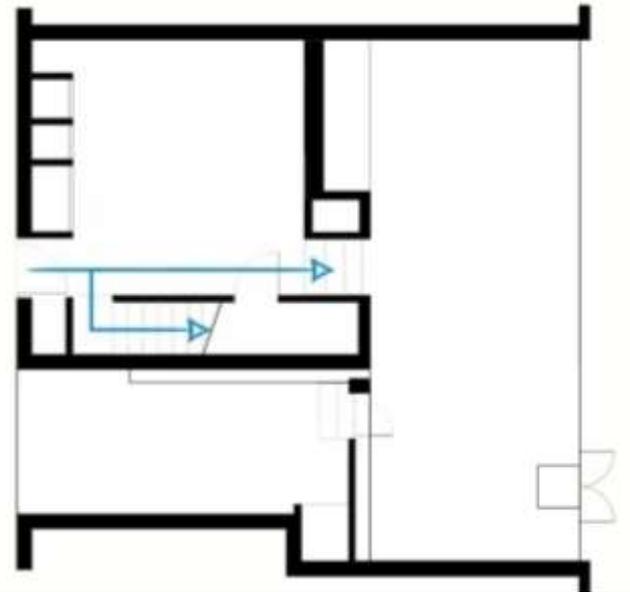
Planta de Murray Mews mostrando el recorrido.
